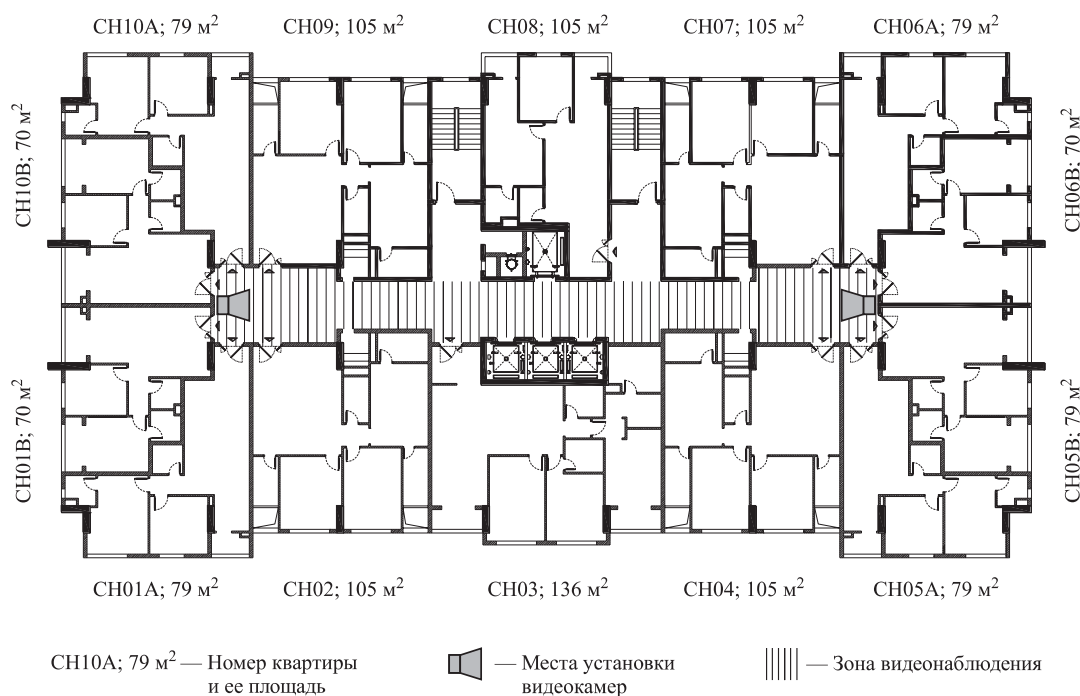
План типового этажа жилого здания и места установки видеокамер
